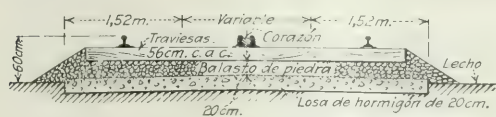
LOSA DE HORMIGÓN DEBAJO DE DESVIADEROS
